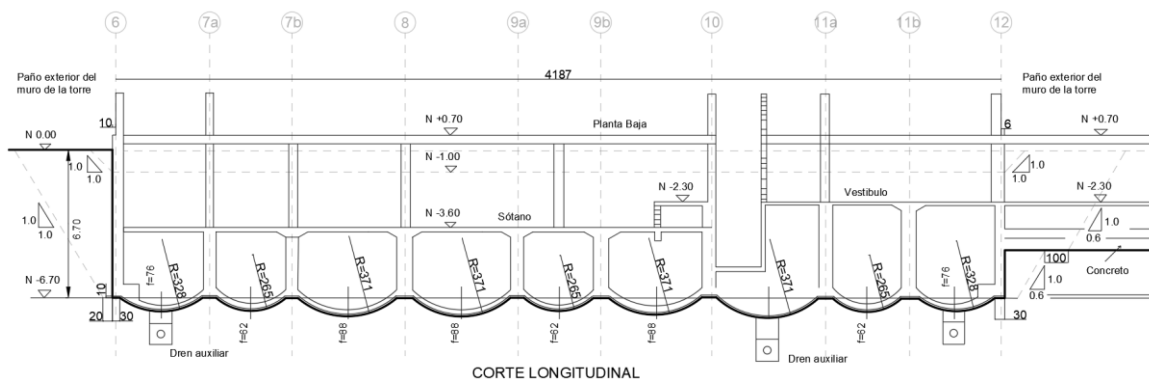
Cajón de cimentación, muros y contratrabes. Corte longitudinal en cm (adaptado de SRE, 1963).
